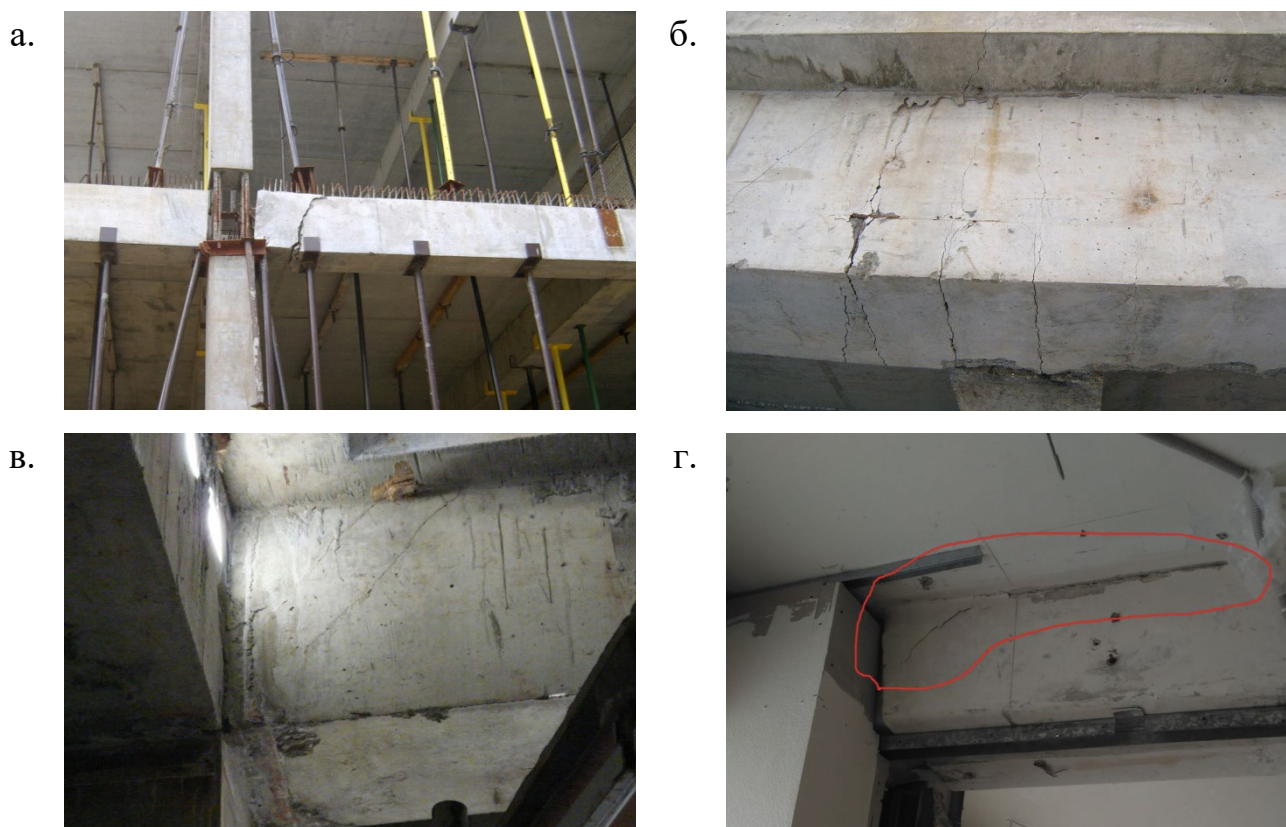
Фрагменты перекрытий многоэтажных зданий.
